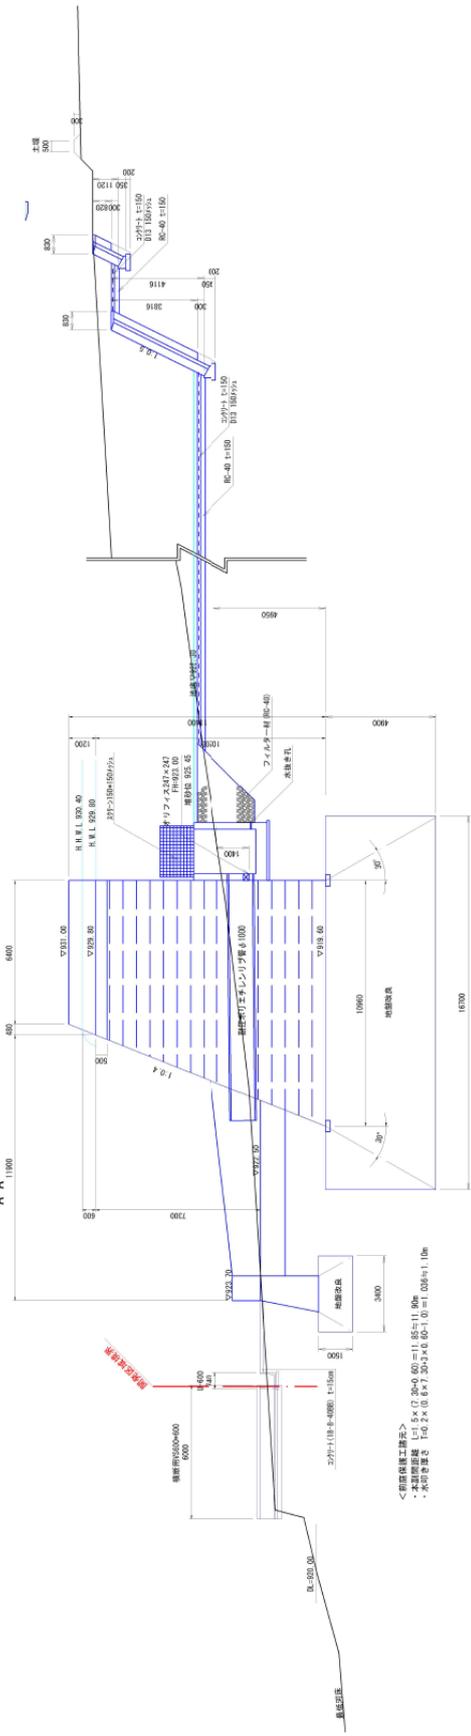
(11) No.7 調整池計画図 (断面図)
